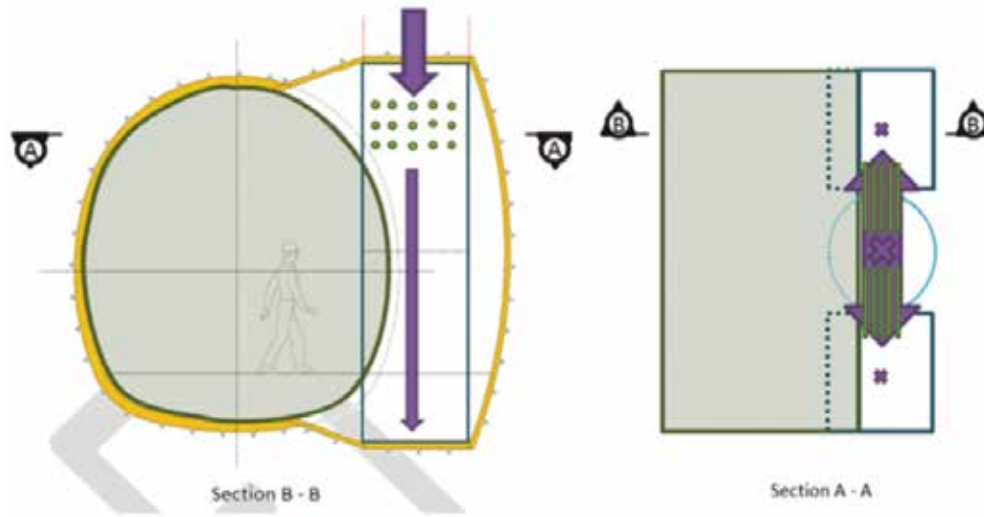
\_ Pilote parcialmente interceptado Vista transversal y en planta
